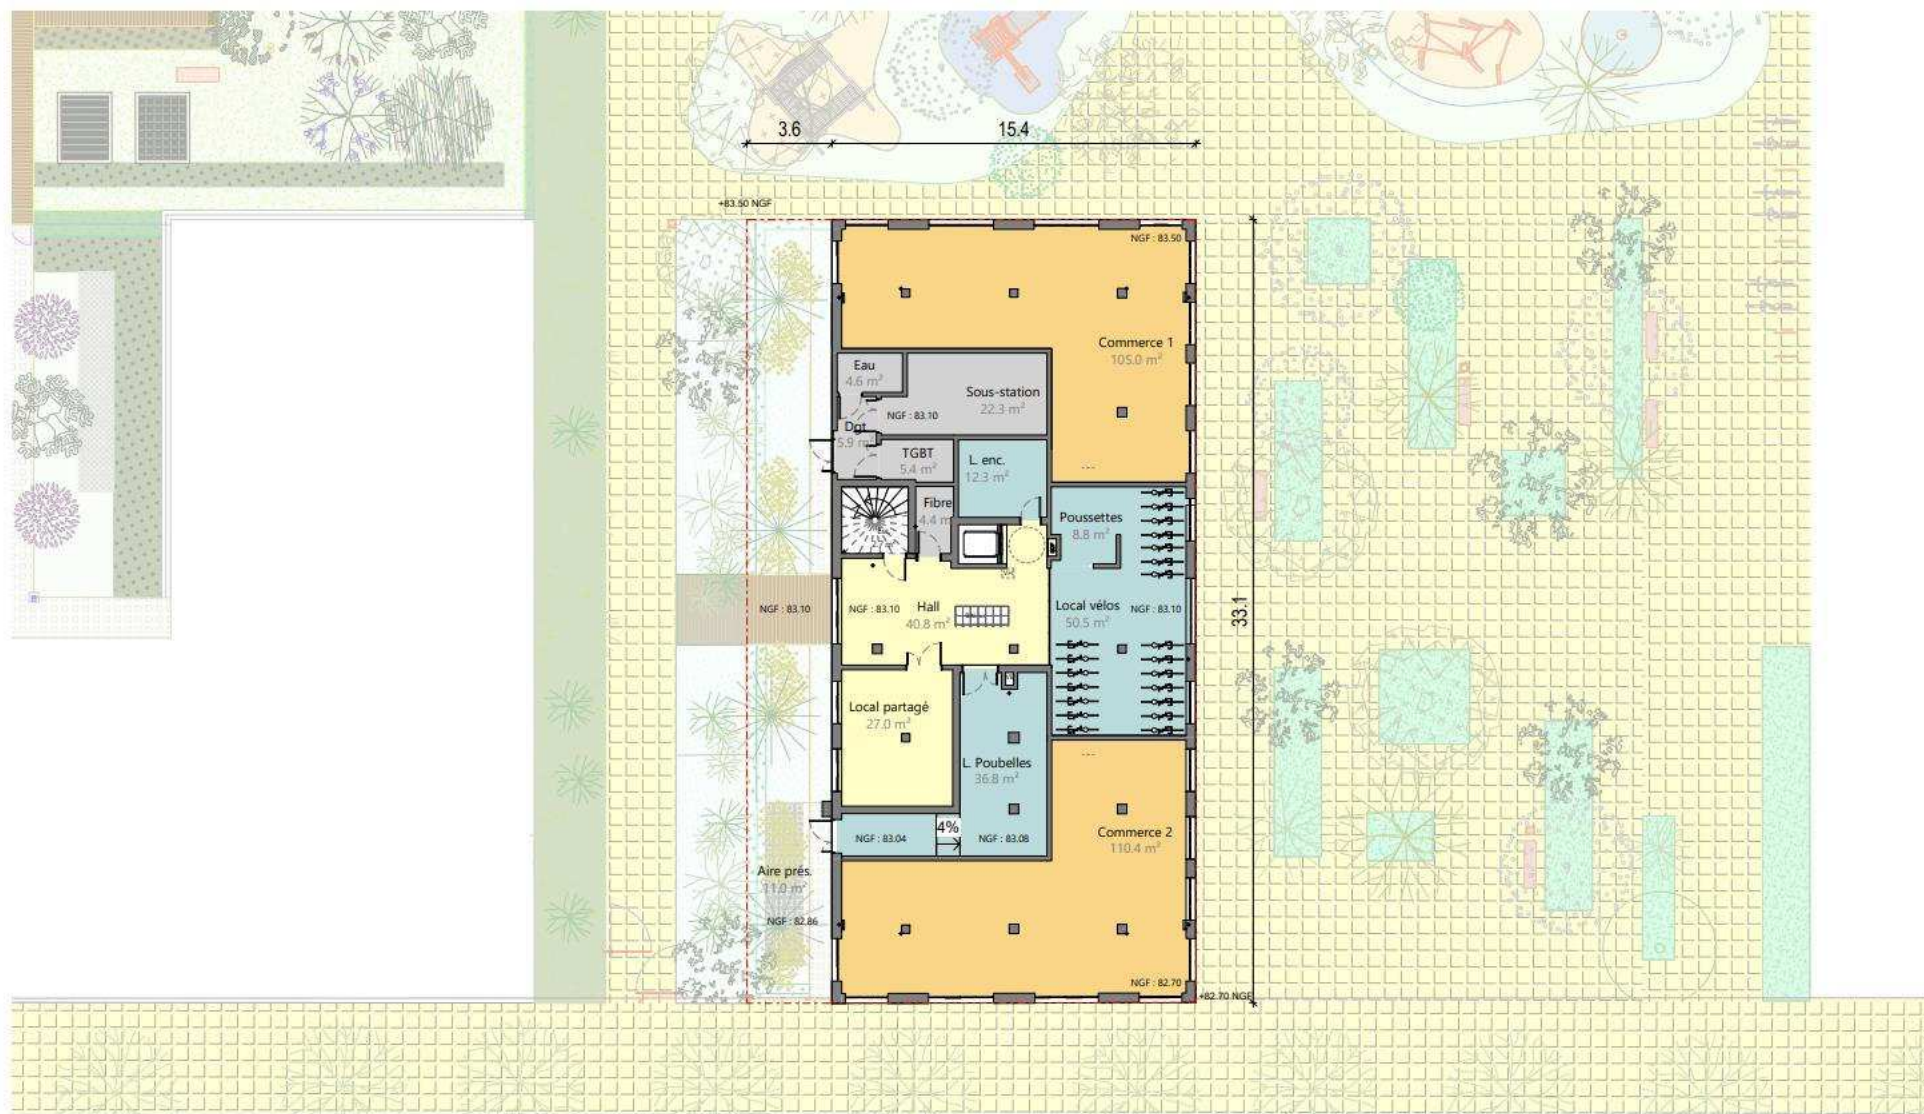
Plan masse du RDC des bâtiments du lot 4.4
